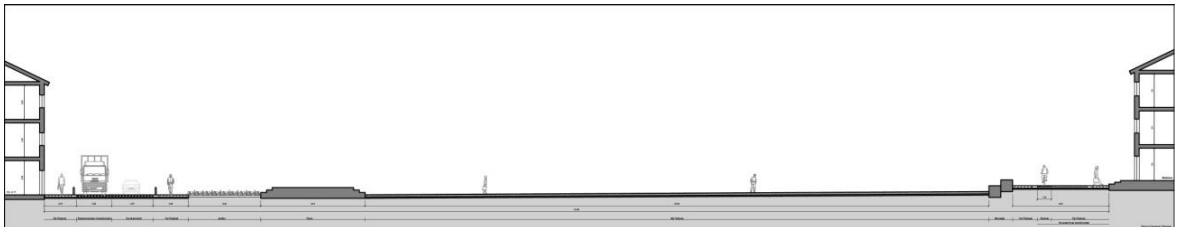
Perfil do Largo General Silveira (anexo b.10)
